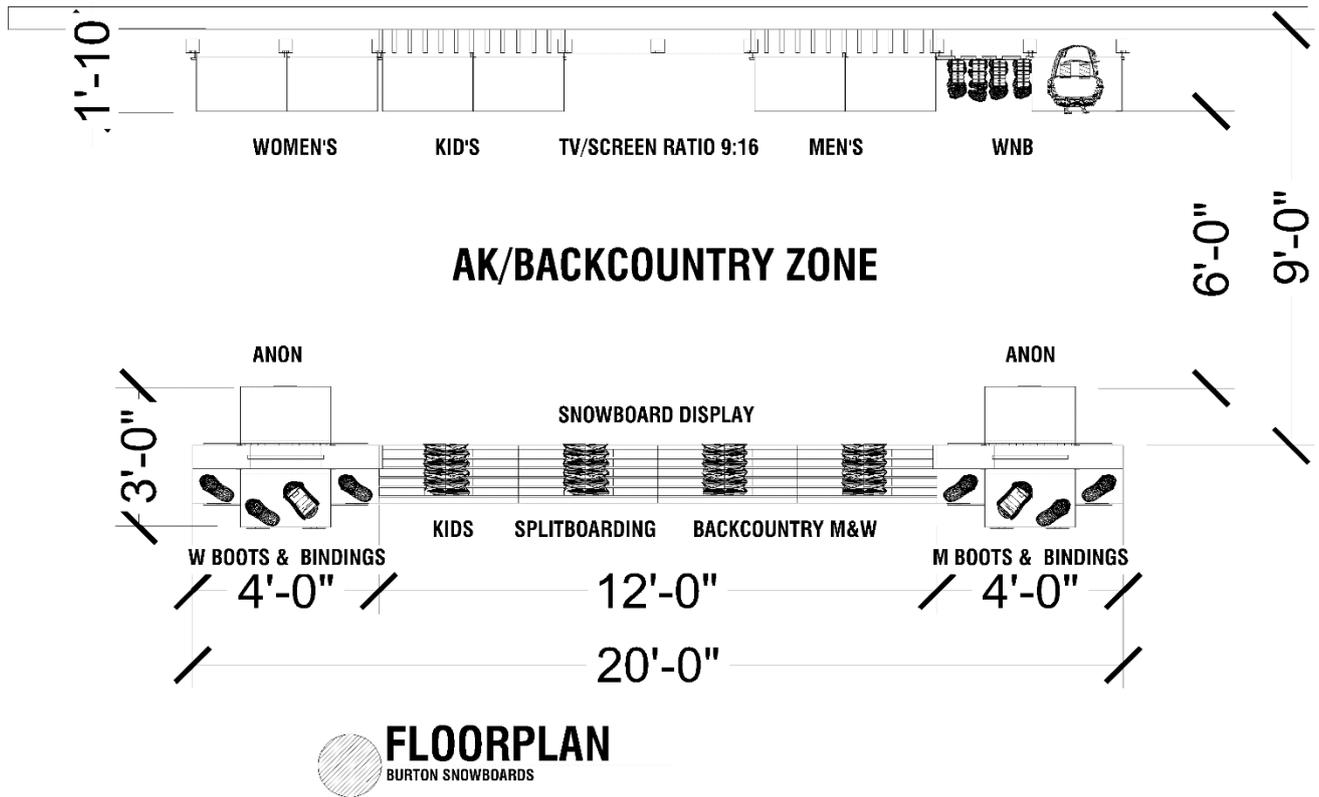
Planta arquitectónica. Fuente: elaboración propia.
